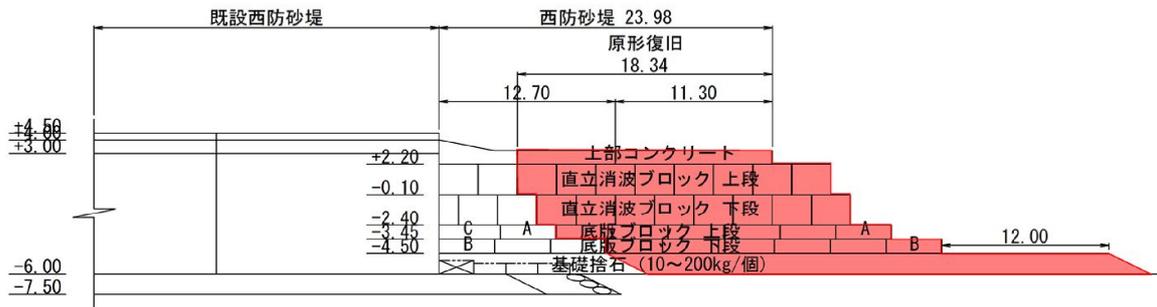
134 No.8 大洗港区_西防砂堤の断面図 (復旧後)
